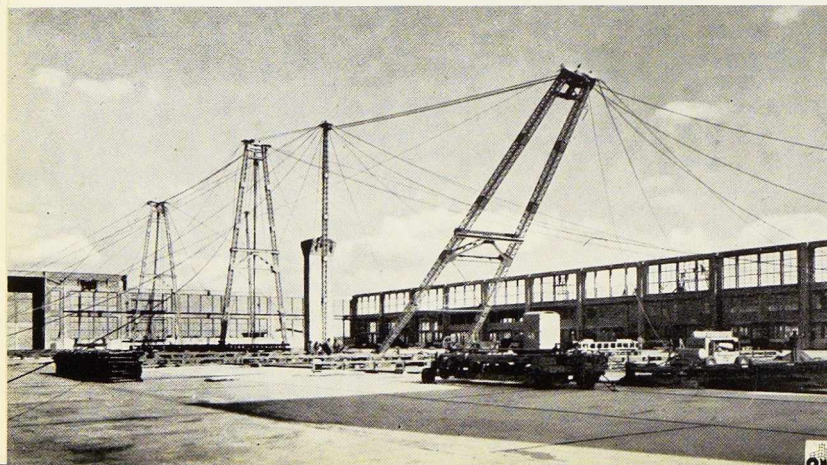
Bigues de 25 m de hauteur employées pour le montage de la maitresse-poutre.
